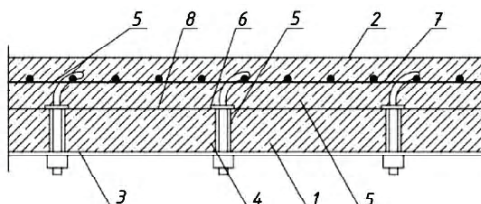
Устройство железобетонного нарастивания сверху плиты при недостаточном сцеплении нового бетона со старым: 1 – усиваемая железобетонная плита; 2 – железобетонное нарастивание; 3 – стальная полоса, прикрепленная к плите анкерными стержнями; 4 – анкерные стержни с крюками, установленные в просверленные отверстия; 5 – отверстия, просверленные в плите; 6 – шайбы; 7 – арматурная сетка, прикрепленная к плите анкерными стержнями; 8 – поверхность усиваемой плиты, подготовленная к бетонированию.
